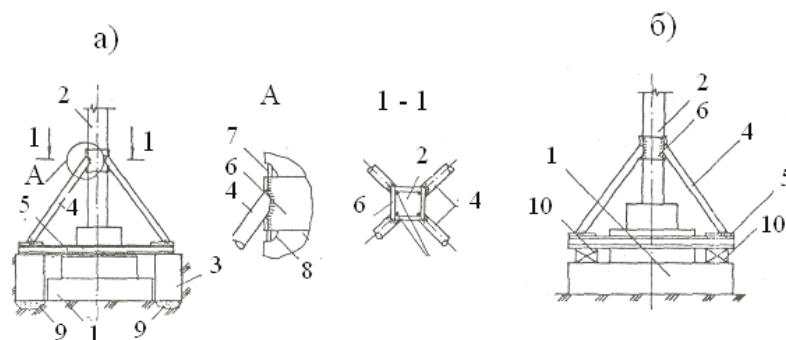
Передача части нагрузки от колонны на бетонные элементы усиления (а) или на обрез фундамента (б):
